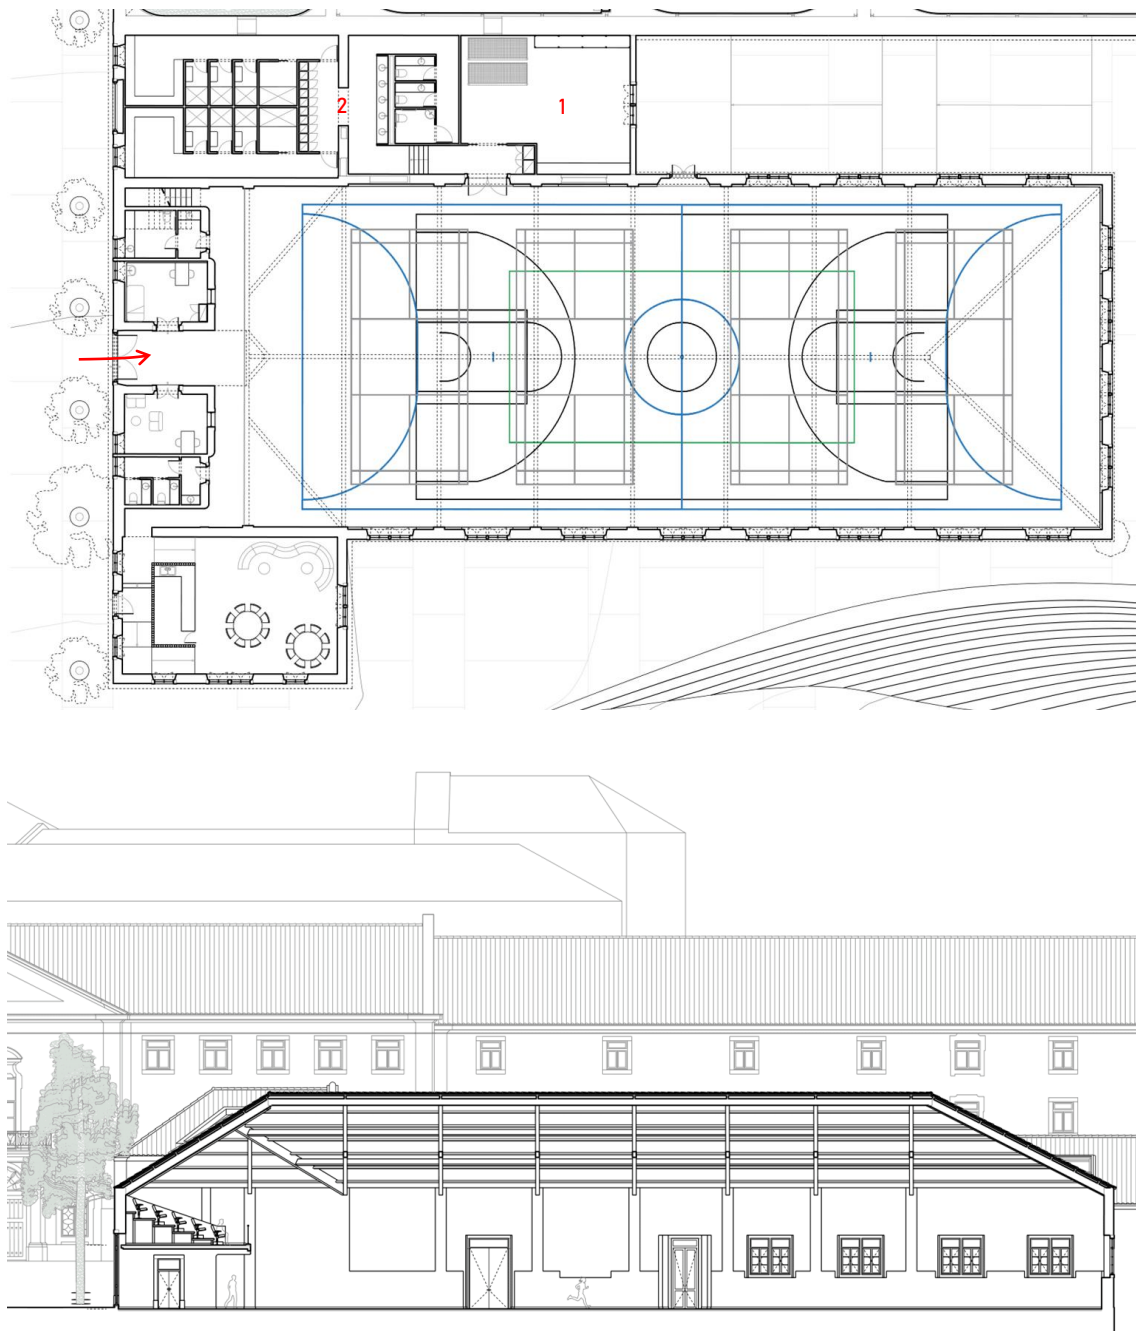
| Planta do piso 0 e corte do pavilhão gimnodesportivo (de cima para baixo, respectivamente) (sem escala).
